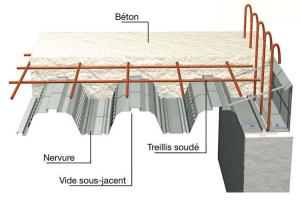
Plancher mixte (collaborant). Source: https://www.futura-sciences.com/maison/definitions/construction-maison-plancher-collaborant-17857/.
